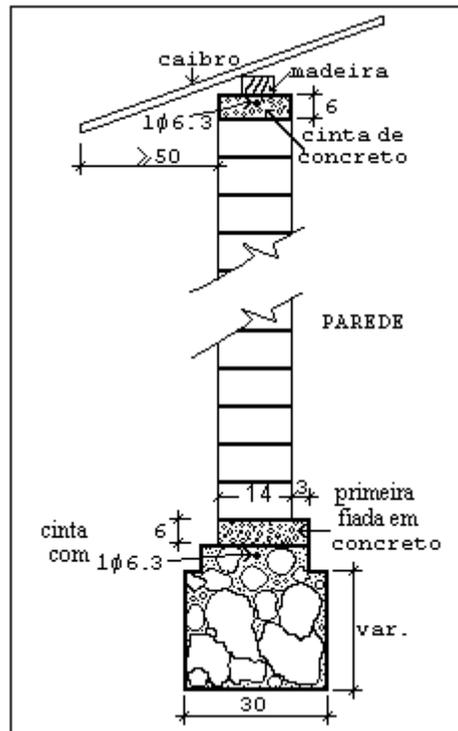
Conjunto fundação, parede, cintamento.
